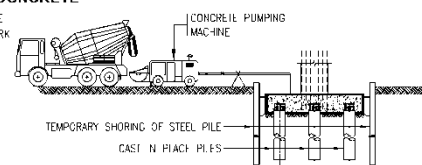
基礎工—PC箱桁橋（セパレート区間）の施工方法
